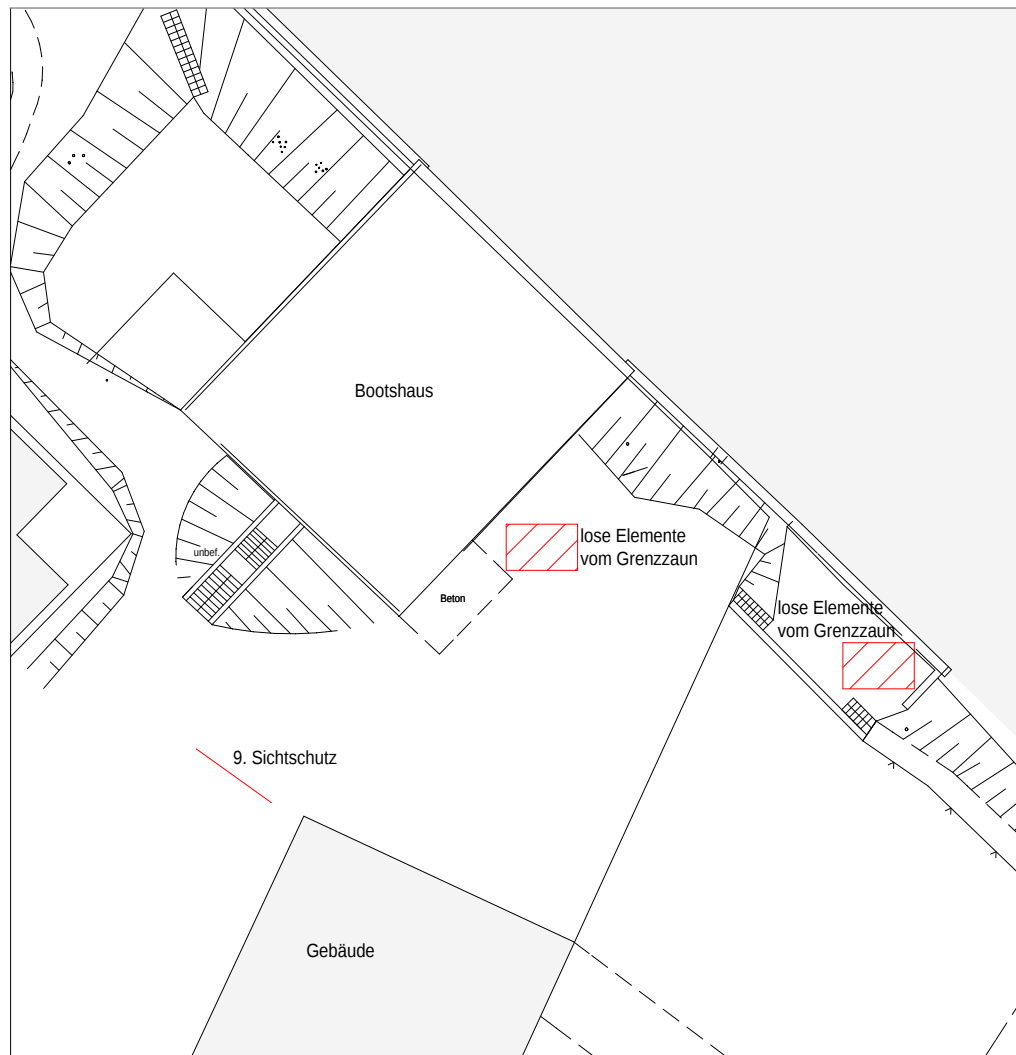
Lageplan Tor und Sichtschutz I umherliegende Grenzzaunelemente (büro west I Vermessungsplan 2014)
